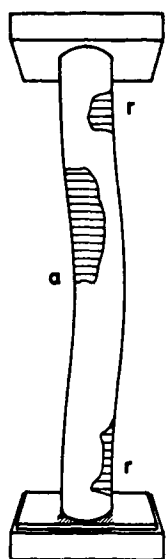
Grietas de falla de columna por pandeo según Richart et al.¹⁷
